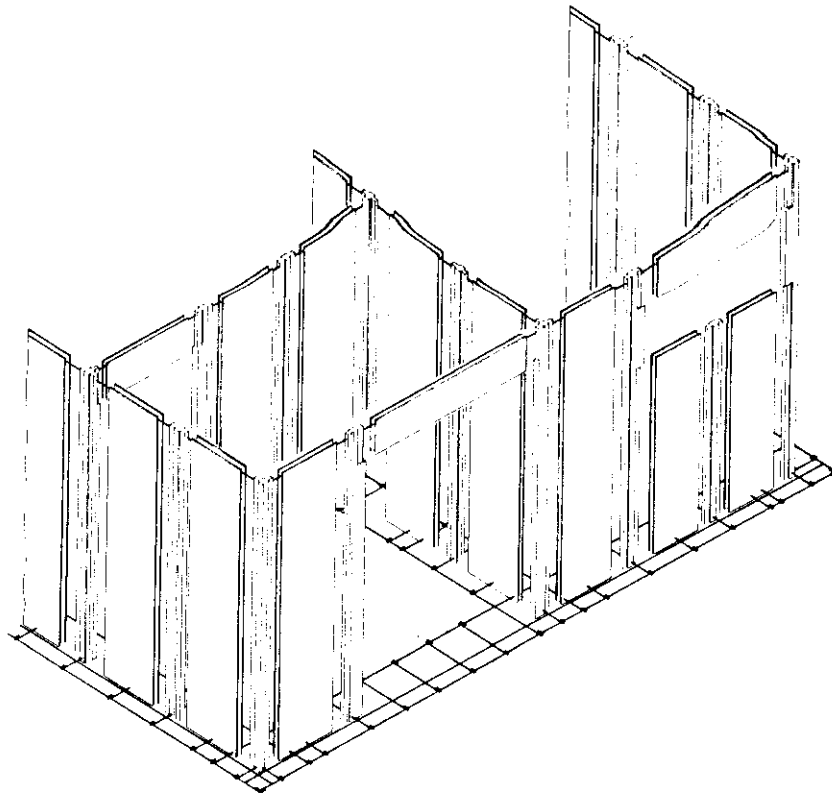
SISTEMA DE MONTAGEM DA ARMADURA DE FIXAÇÃO DOS COMPONENTES NO CONTRAPISO E CINTA DE AMARRAÇÃO
